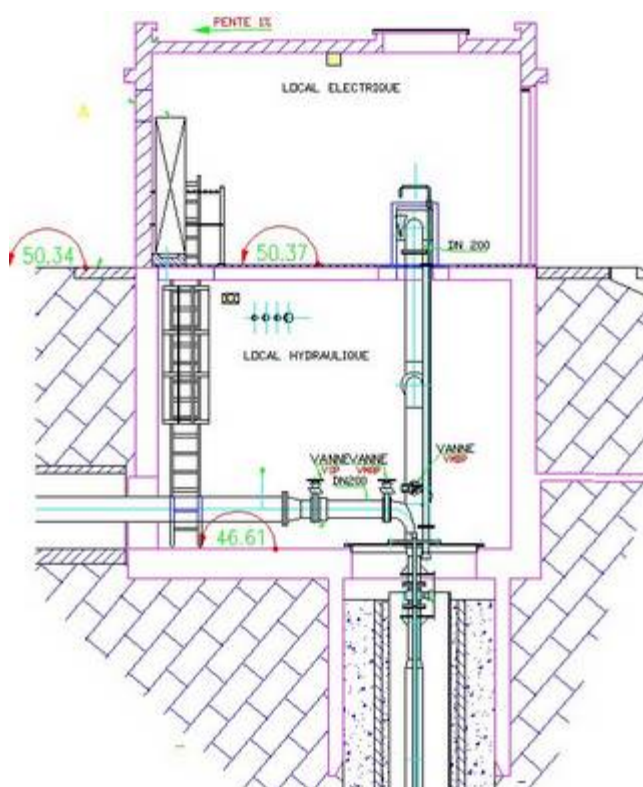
Coupe type des aménagements de surface sur les puits de captage (Sagep)
